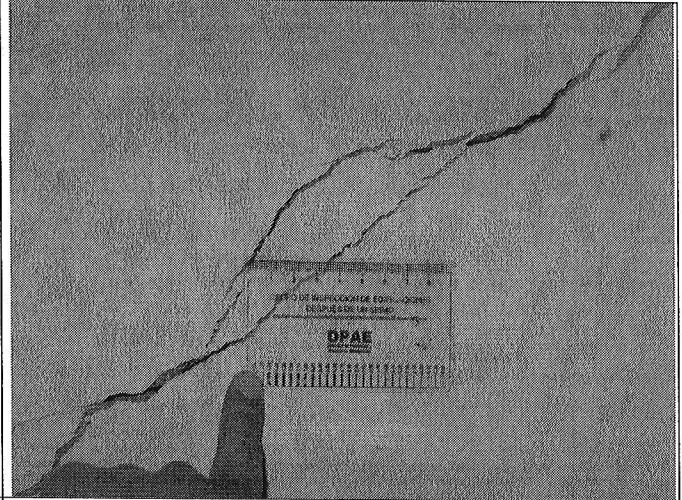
Fisura en muro, presentada en el costado este, del lote 10 de la manzana 5, con un ancho de 2mm aproximadamente (De acuerdo a la Figura 1)
